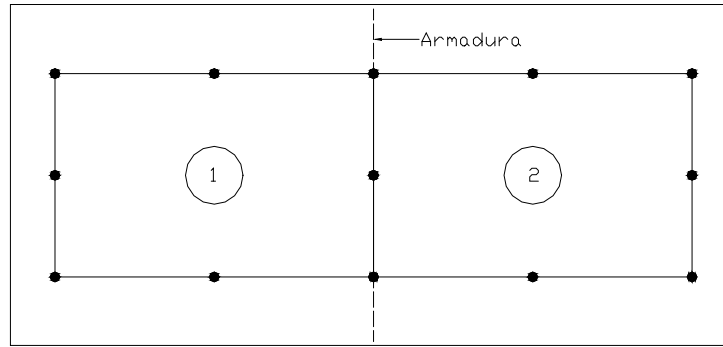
barra de armadura localizada numa aresta em comum de dois elementos de concreto
